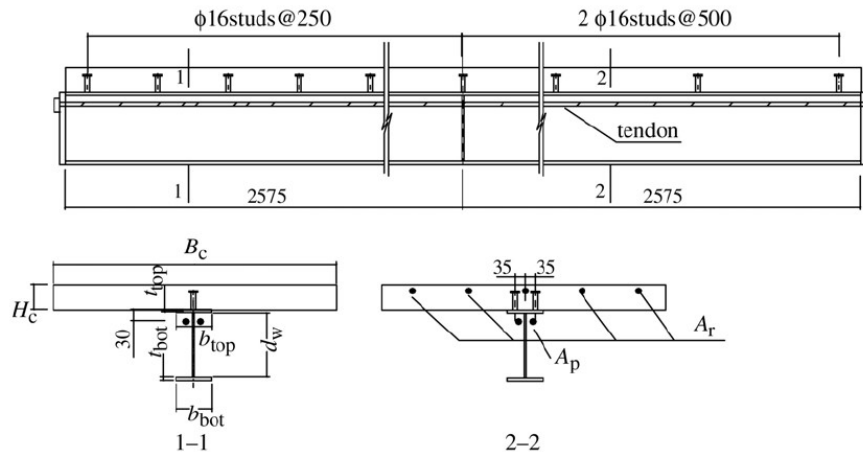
Geometria das vigas ensaiadas por Safan e Kohoutková (2001)
